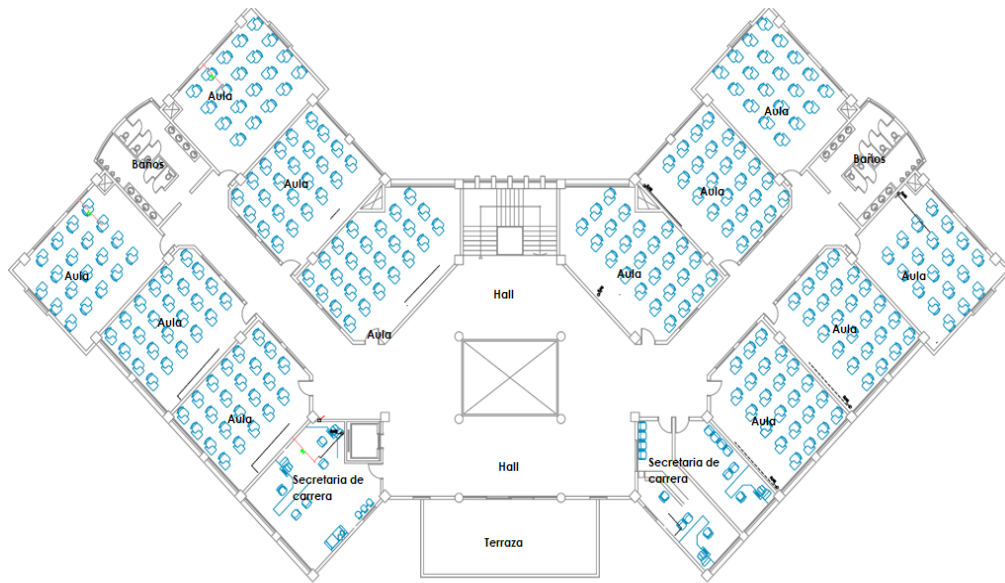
Planos de Infraestructura Segundo Piso Aulas
